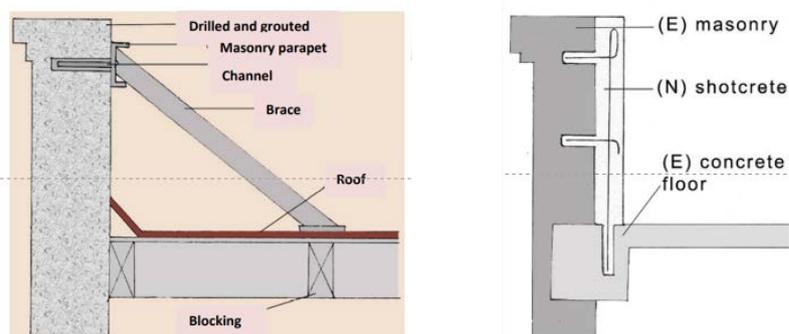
Arriostramiento de petos de cubierta con la estructura del forjado.
